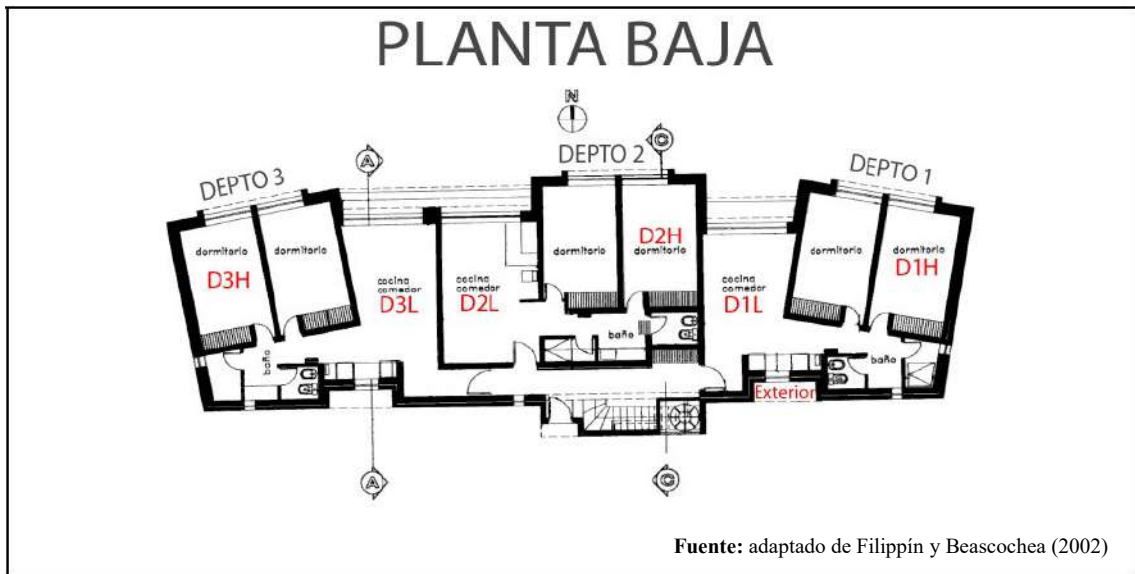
Disposición de los sensores en los departamentos de planta baja
